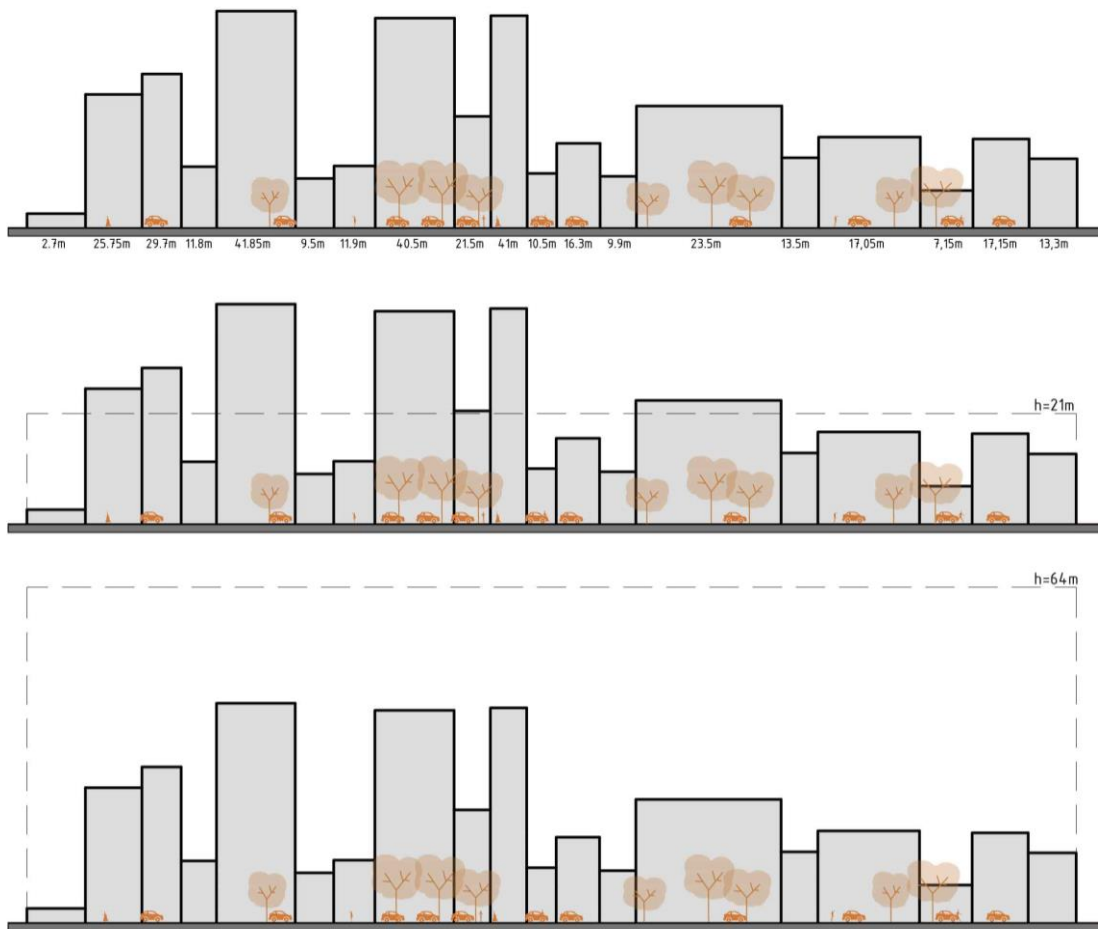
Vistas 3 do terreno analisado para as fachadas da Rua Washington Luis.
